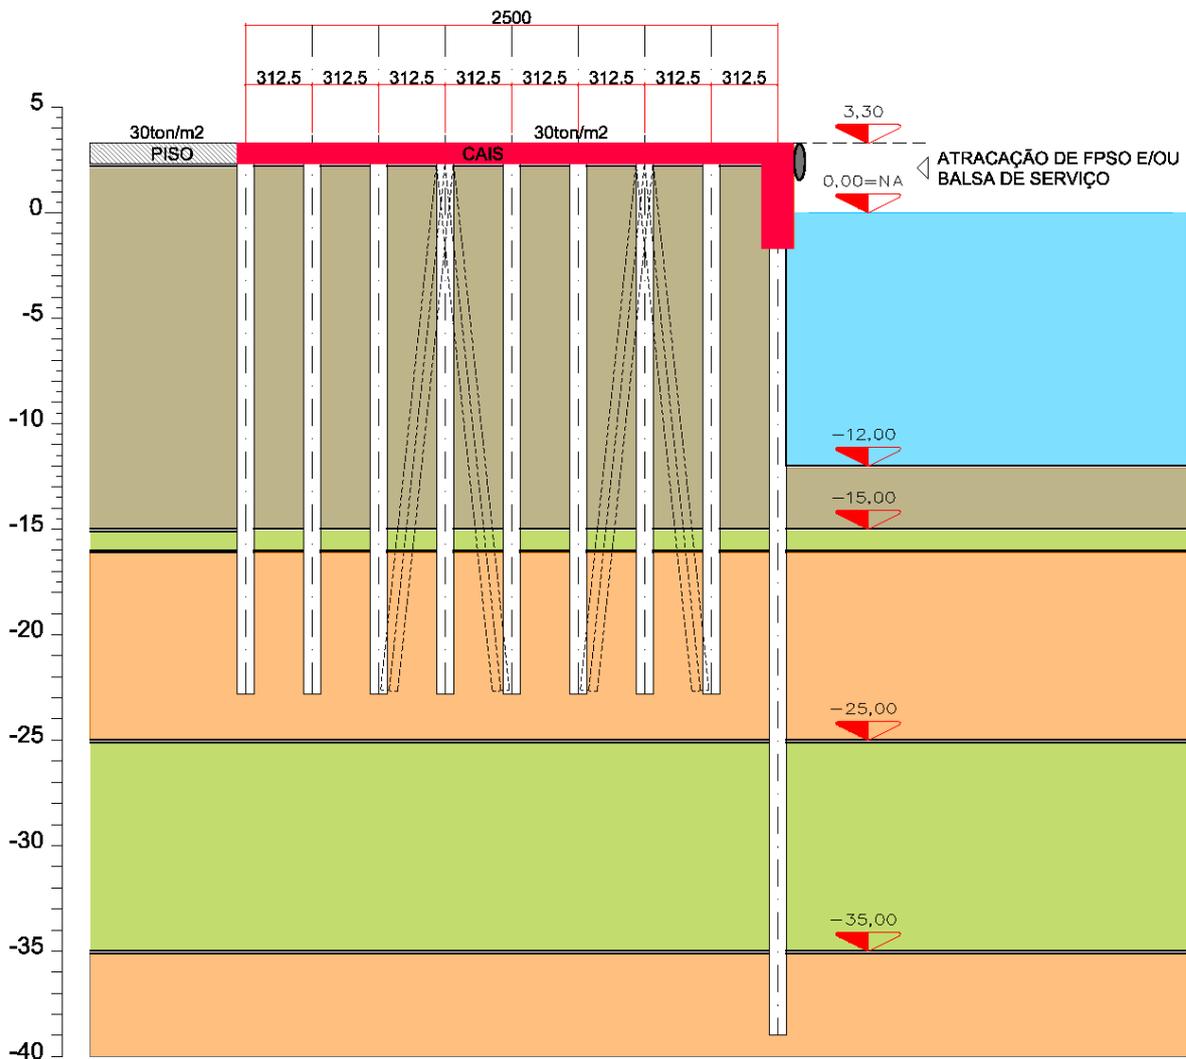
A– Opção A - Estrutura do cais, corte transversal - Estacas
